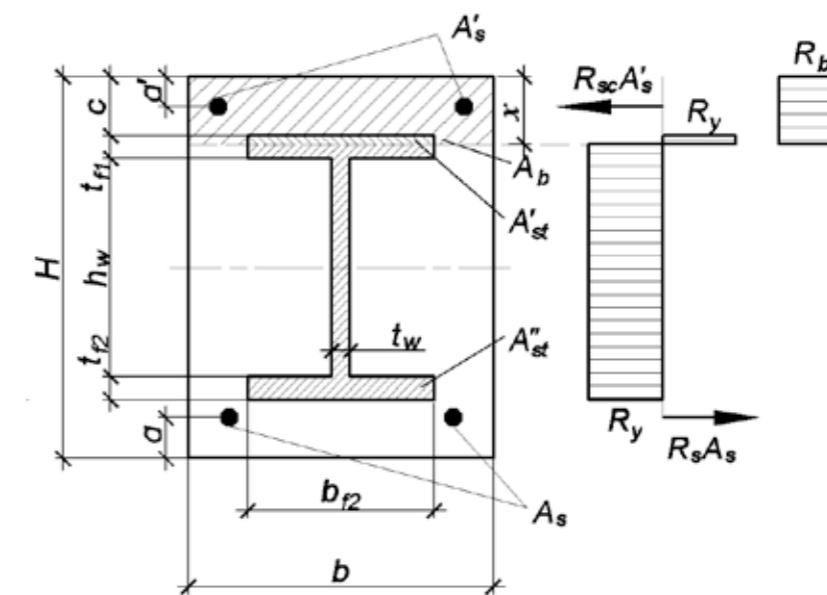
Случай, когда нейтральная ось пересекает сжатую (верхнюю) полку жесткой арматуры в обетонированной балке прямоугольного сечения
